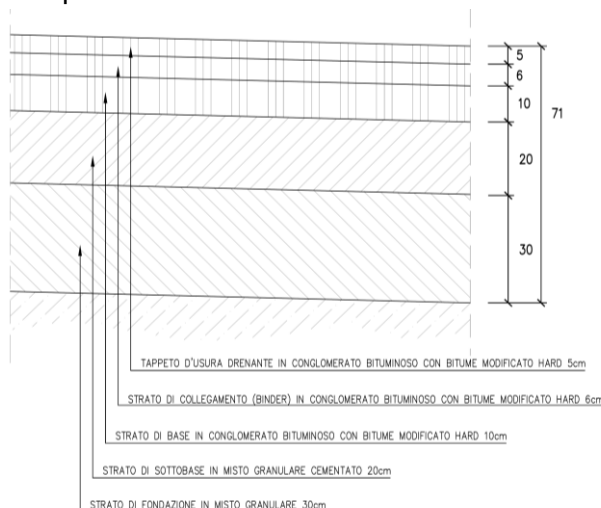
Particolare pacchetto stradale – Asse Principale e Rampe
